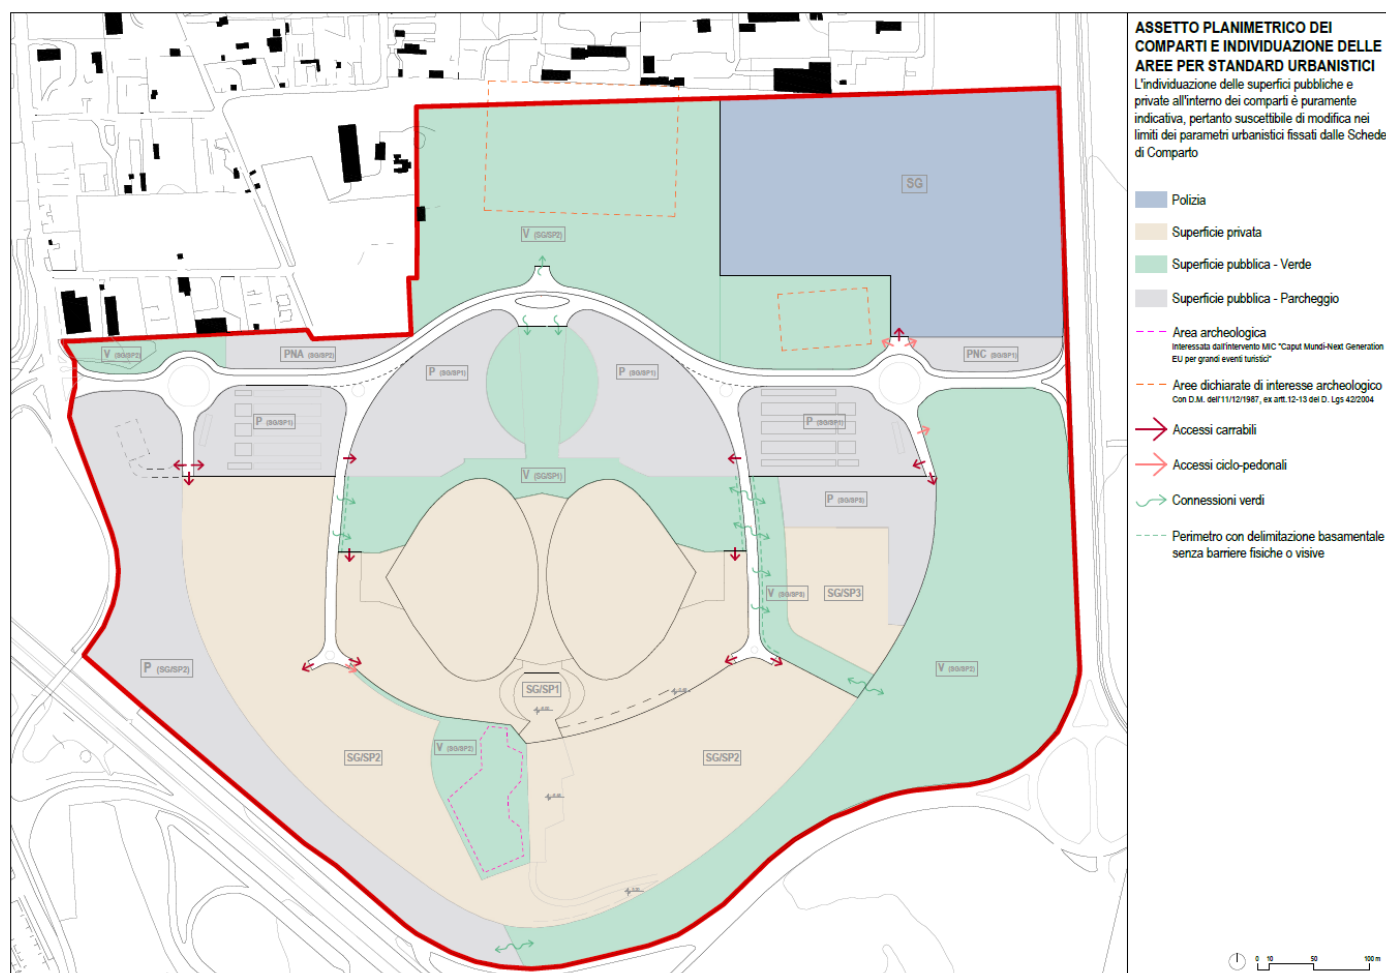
Schema planimetrico di caratterizzazione dei comparti attuativi in aree pubbliche e private (indicativo non vincolante)
